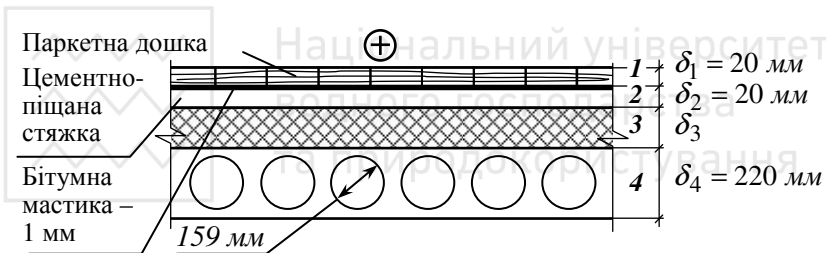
Розрахункова схема конструкції перекриття над підвалом
